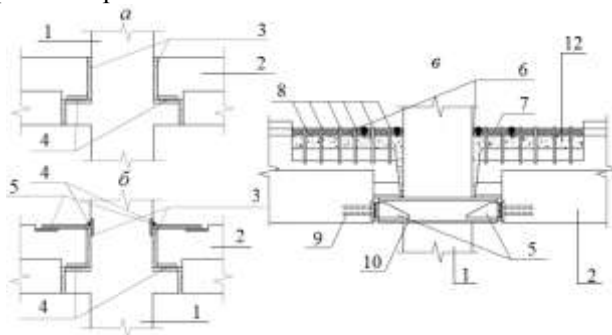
Три варианта конструктивного решения узлов сопряжения ригеля и колонны: а – шарнирный узел, б – полужесткий, в – жесткий. 1 – колонна, 2 – ригель. 3 – бетон омоноличивания, 4 – сварные швы, 5 – соединительные пластины, 6 – арматурные выпуски из ригеля и колонны, 7 – вставка арматуры, 8 – хомуты, 9 – закладная деталь ригеля, 10 – закладная деталь консоли колонны.
